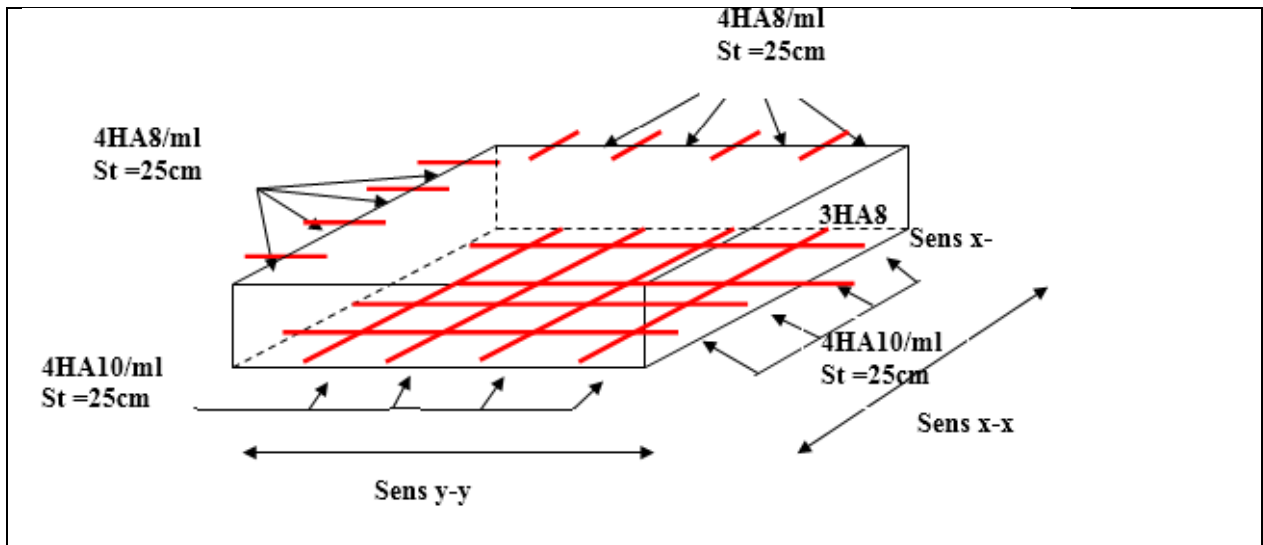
Schéma de ferrailage de la dalle pleine au-dessus de l'ascenseur.
